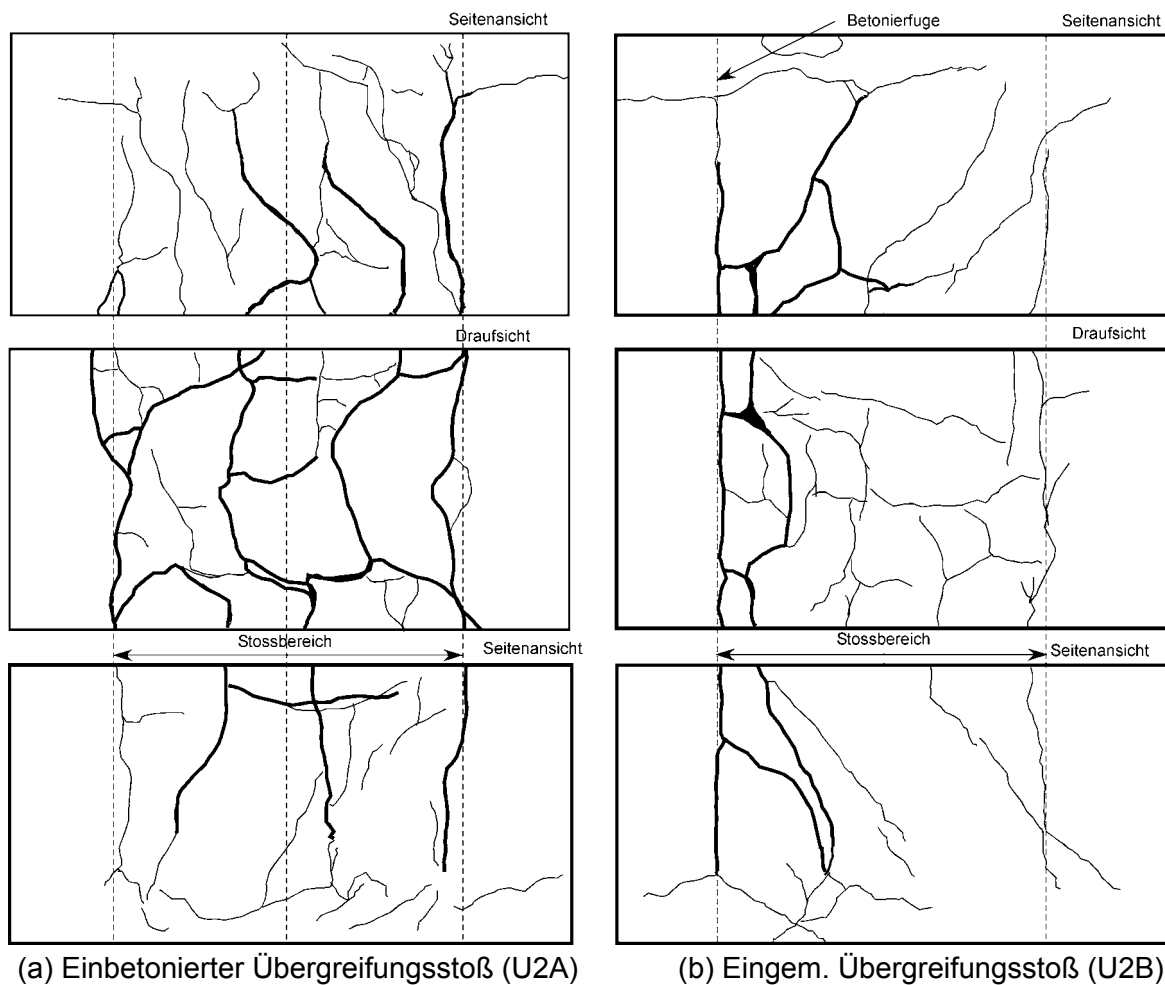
Rissbild im Stoßbereich nach dem Bruch der Versuchskörper; Balken mit Querbewehrung
